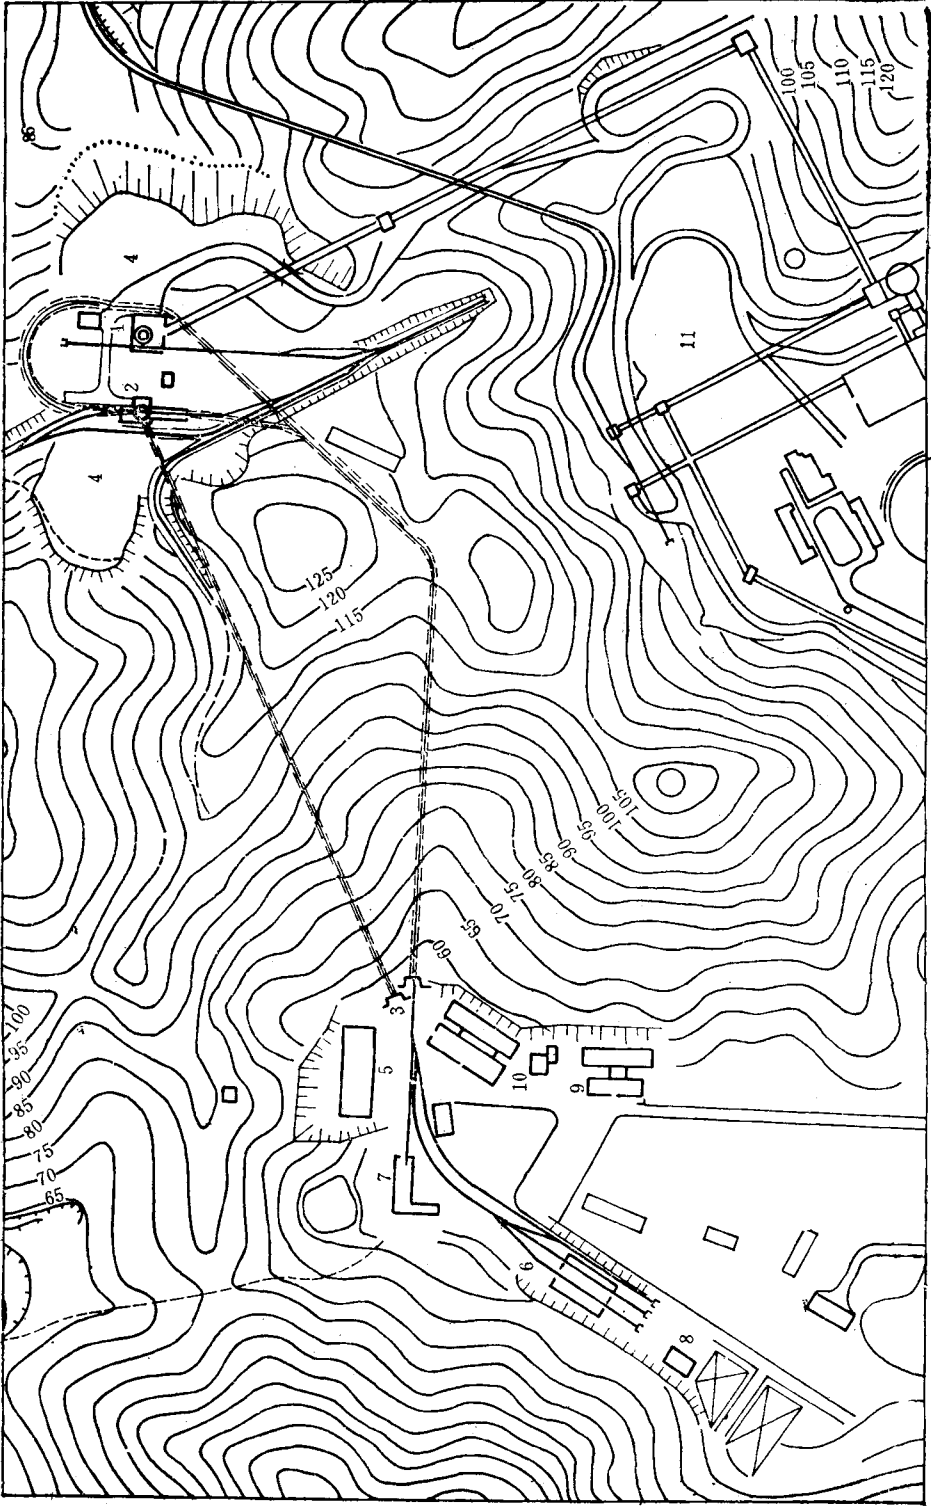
金山店铁矿张福山竖井场地总平面布置图
